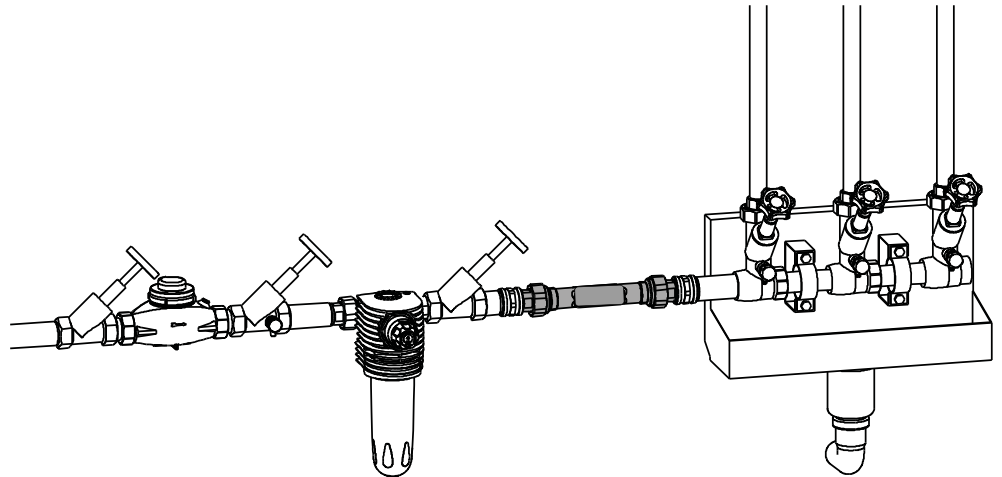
Hausanschluss mit Feinfilter und Passstück
